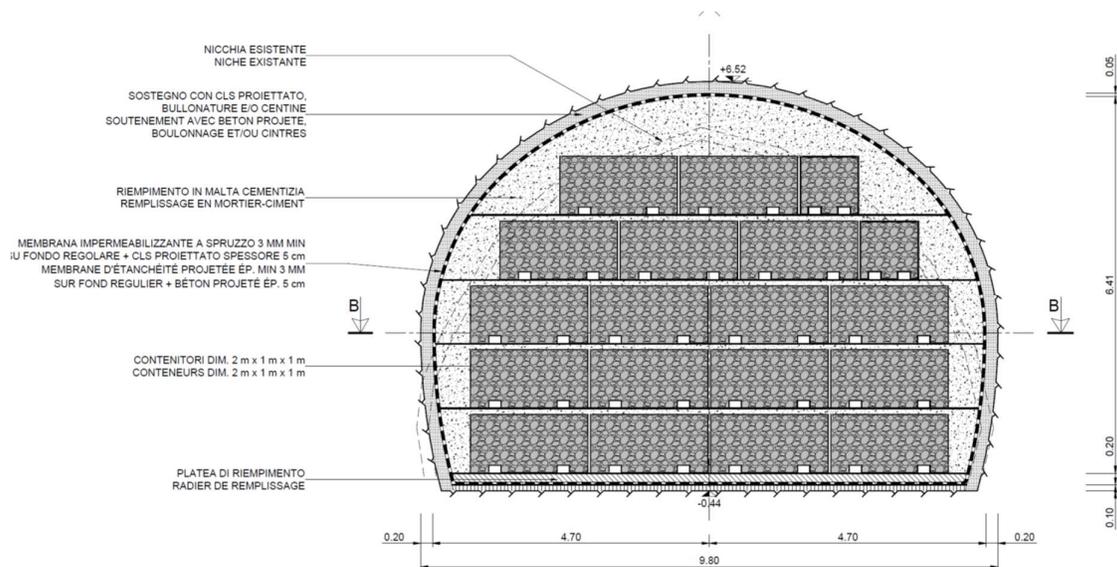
Sezione di stoccaggio nella sezione corrente di Maddalena 1 (PRV\_C3A\_7526\_26-48-10)
